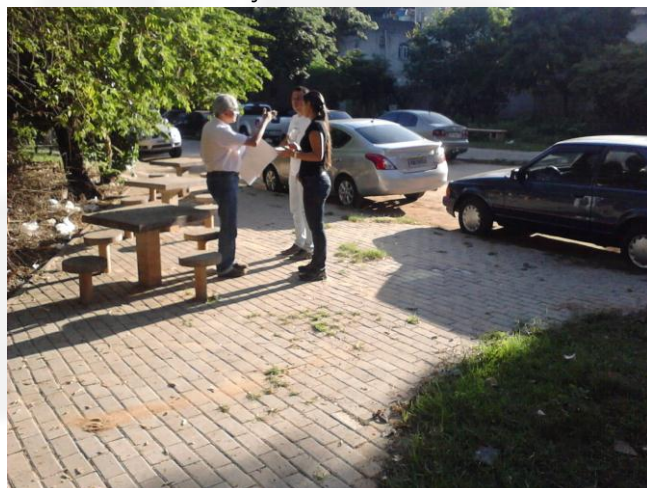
Local da Estação Elevatória EE SD-02 (opção 2)
